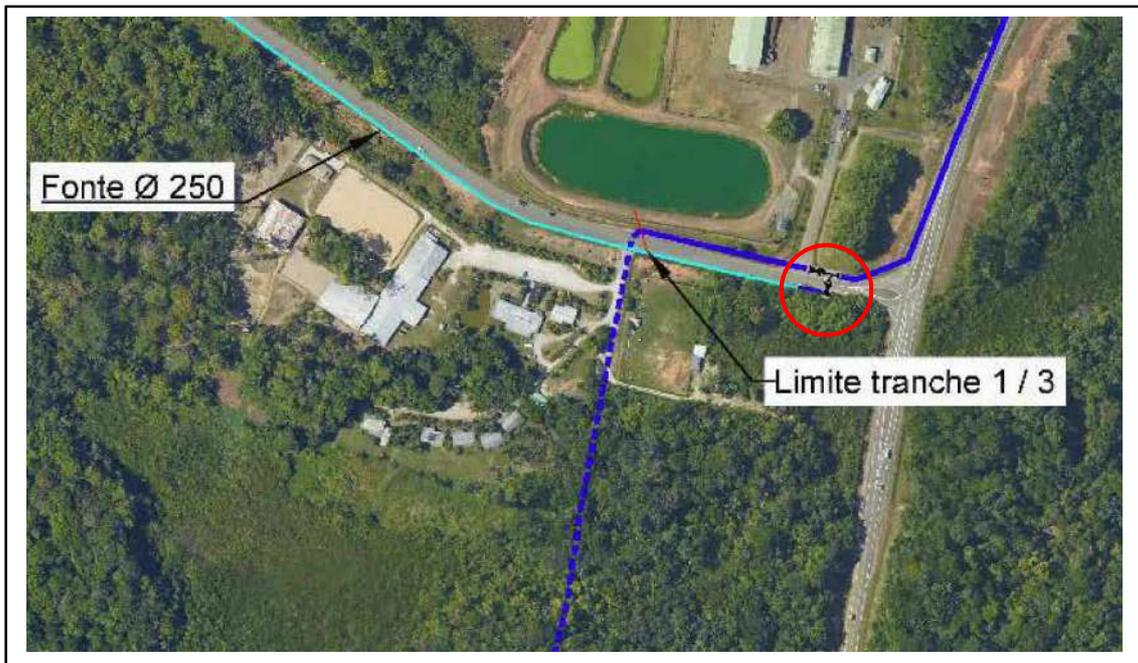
Raccordement à la conduite DN 250 sur la route de la Distillerie – SECOTEM
